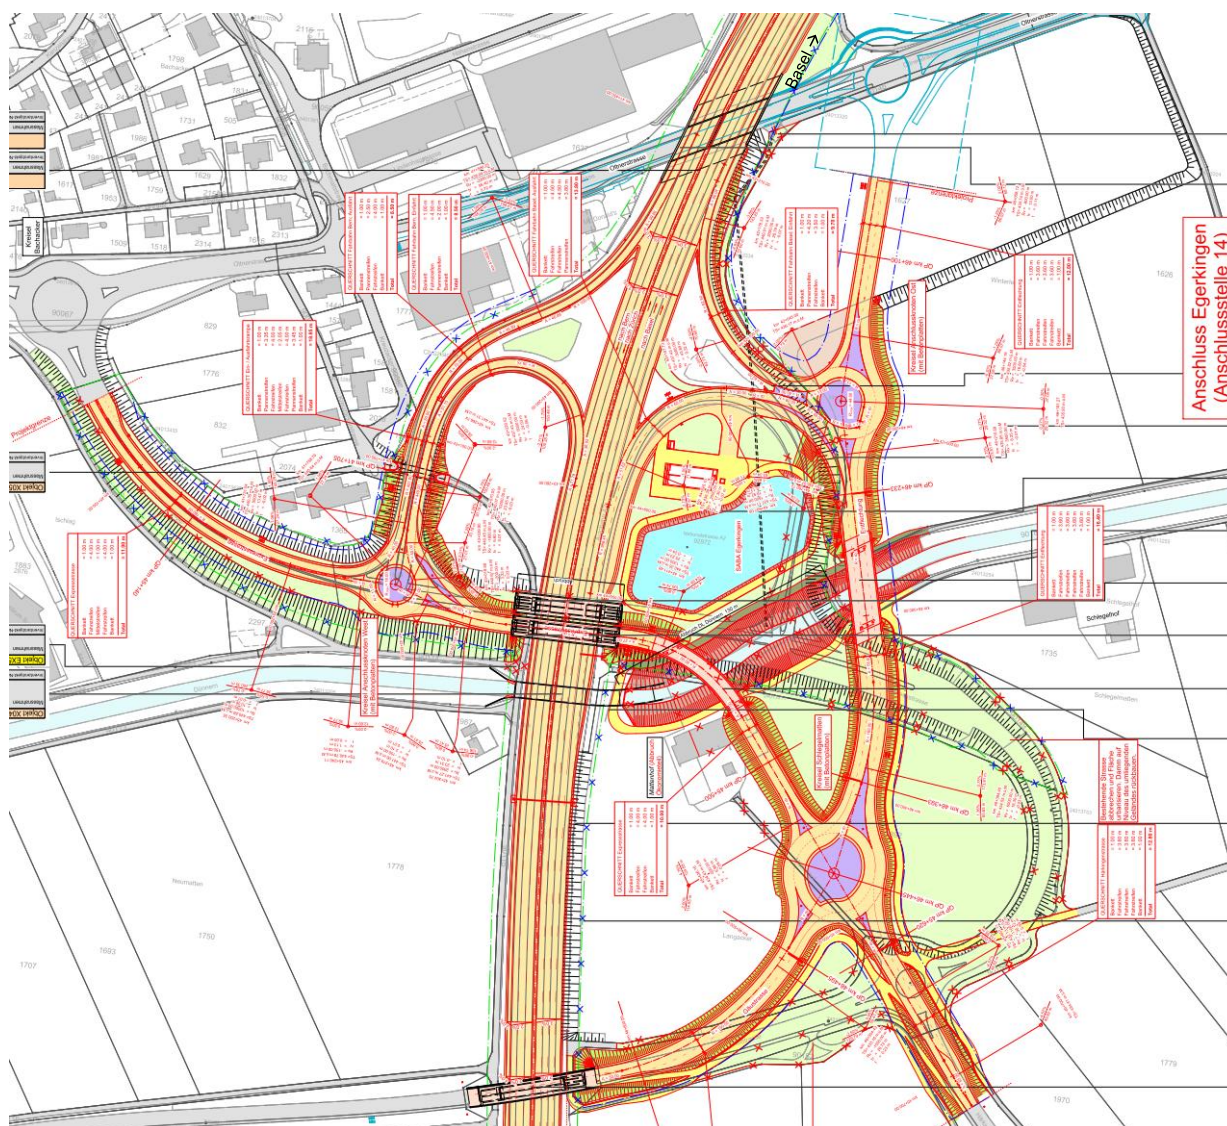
Situationsausschnitt Anschluss Egerkingen
